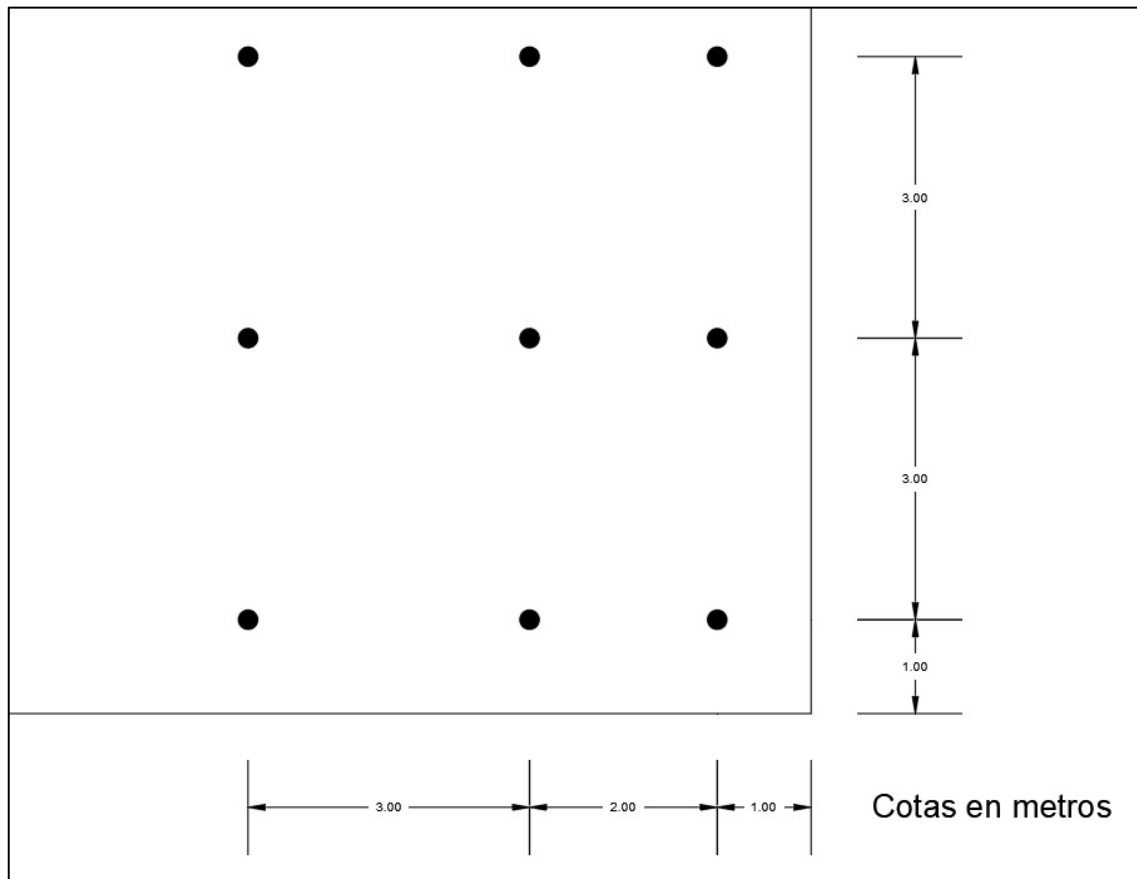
Separaciones micropilotes en las esquinas de la losa de cimentación. Fuente: Elaboración propia.
